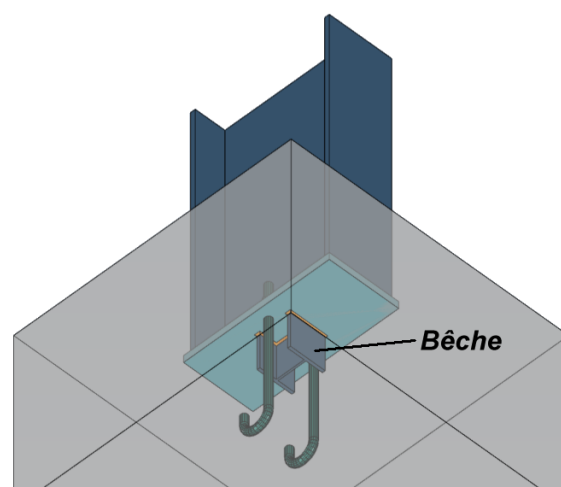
Pied de poteau articulé vue de dessous
